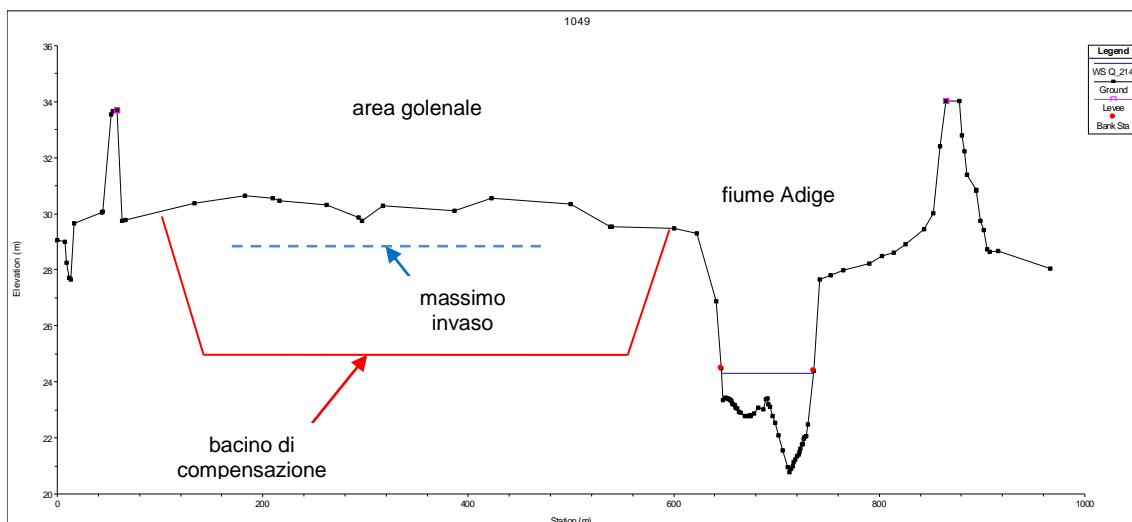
Sezione trasversale 1049 fiume Adige.
